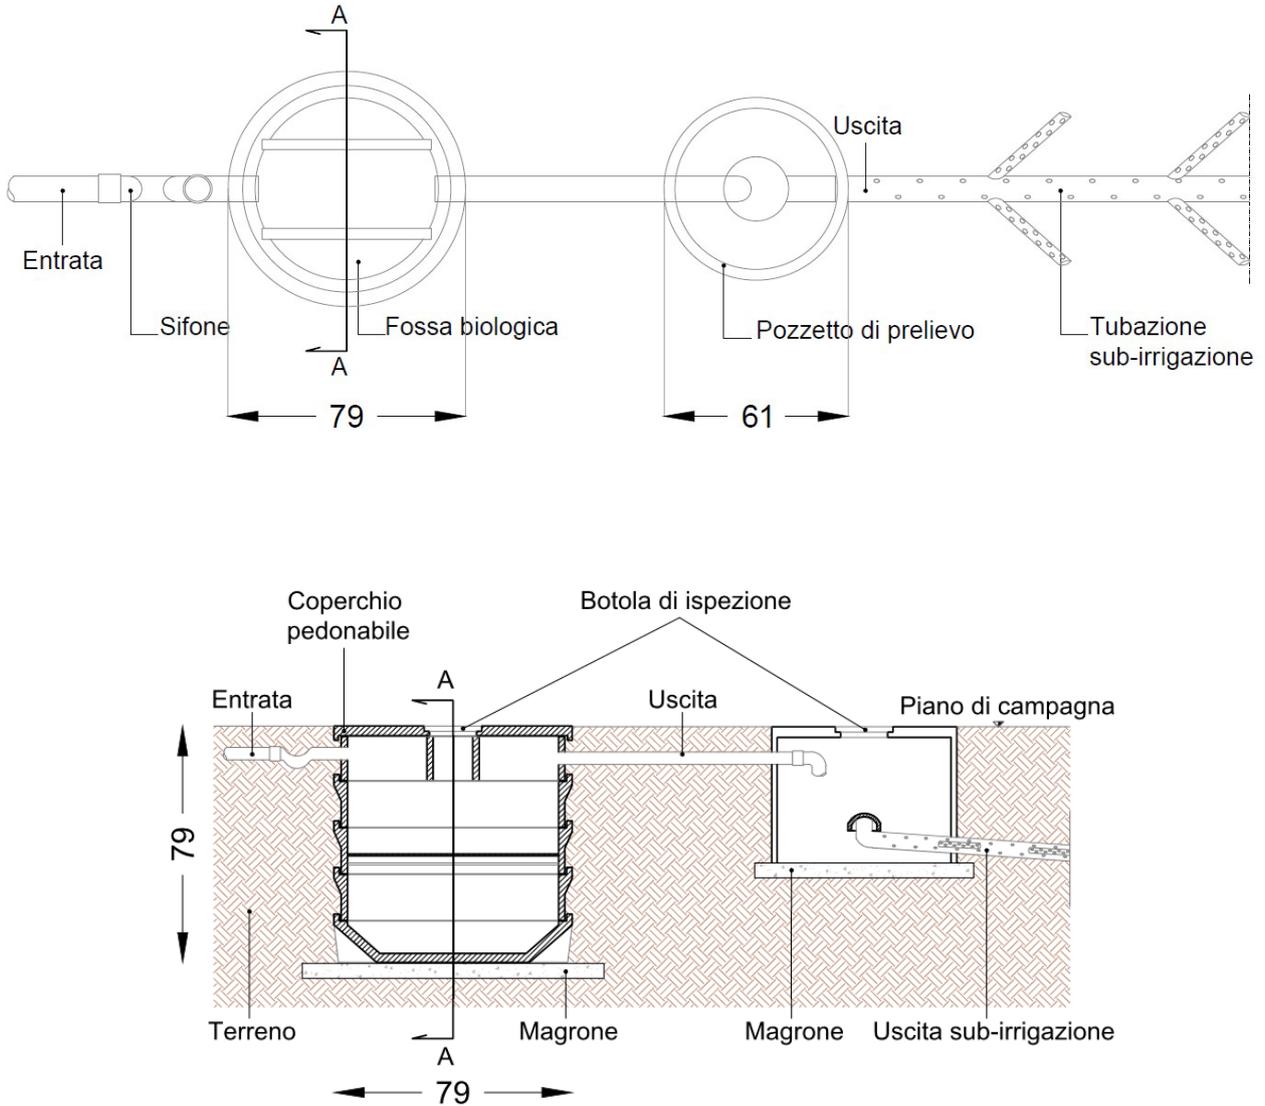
Fossa Imhoff, vista in pianta e sezione; misure in cm
